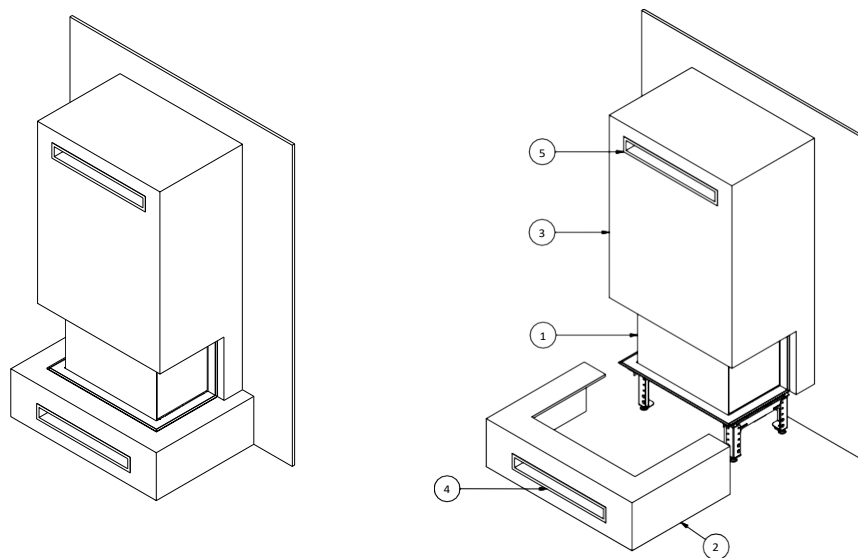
Схема примерного корпуса: 1 - нагреватель; 2 - нижняя часть корпуса; 3 - верхняя часть корпуса; 4 - нижние вентиляционные решетки; 5 - верхние вентиляционные решетки.
